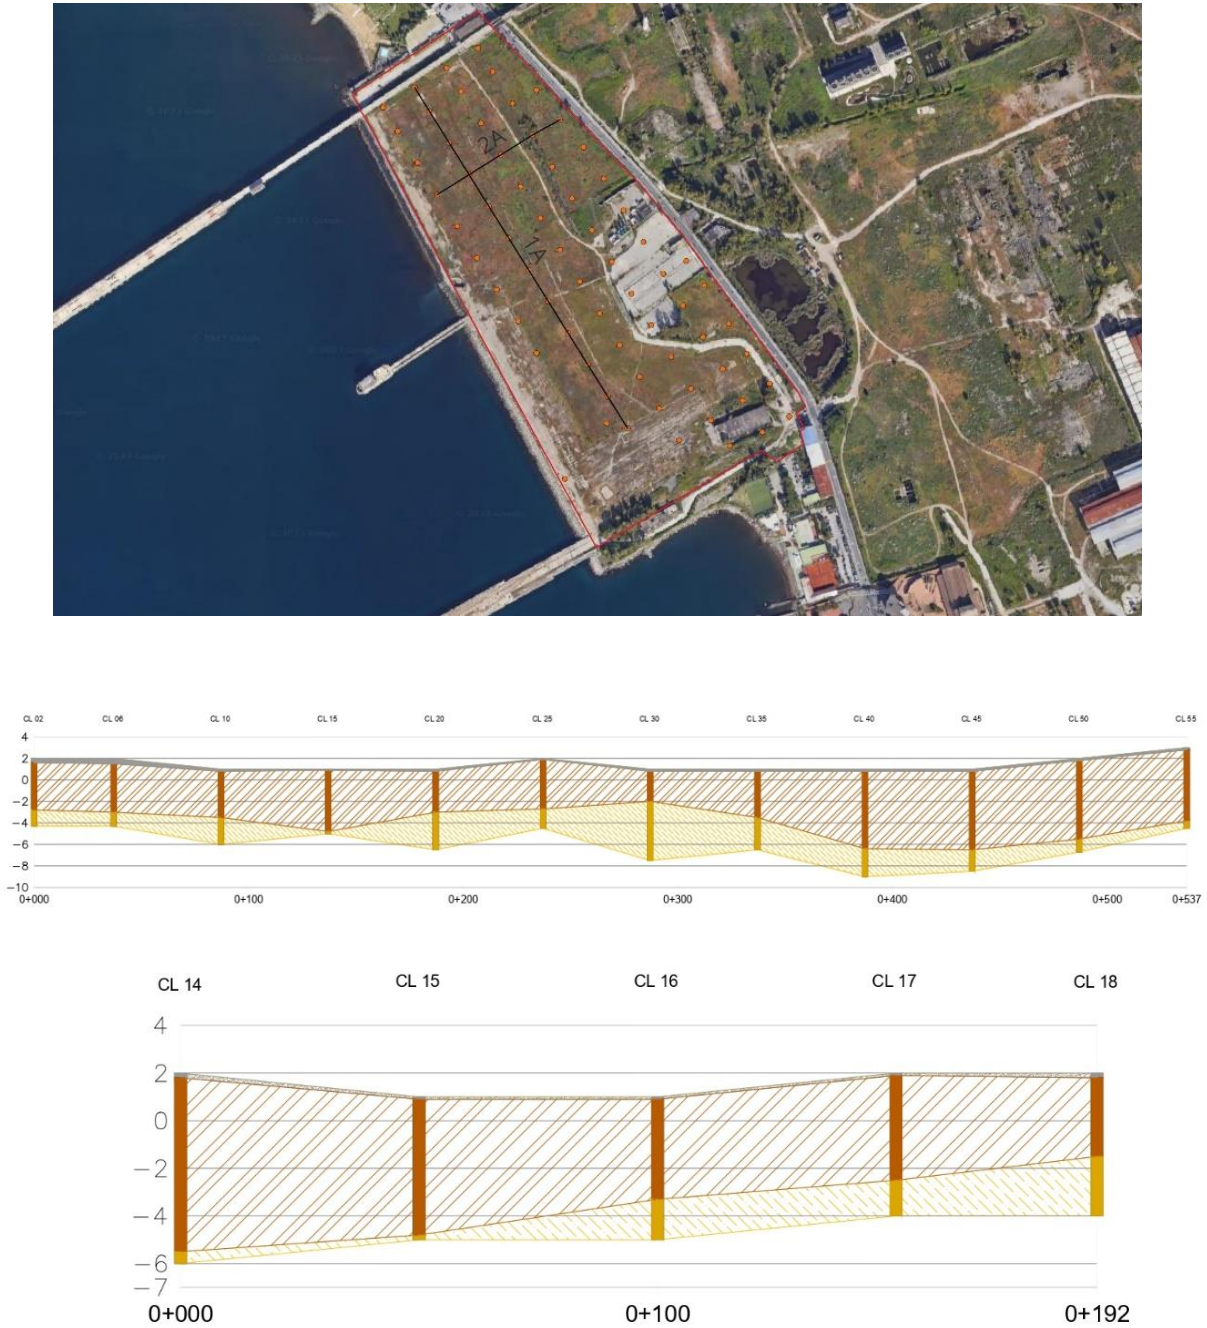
Planimetria con profili delle sezioni ed esempio di sezioni geologiche derivanti dal modello della colmata: in alto profilo longitudinale – sezione 1A, in basso profilo trasversale - sezione 2A
